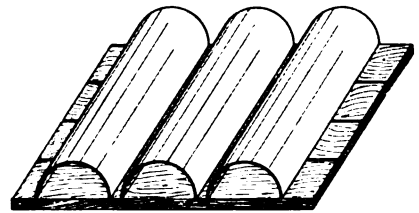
Verschalung einer Rippendecke mit halbkreisförmigen Blechschablonen und durchgehender Schalung.
